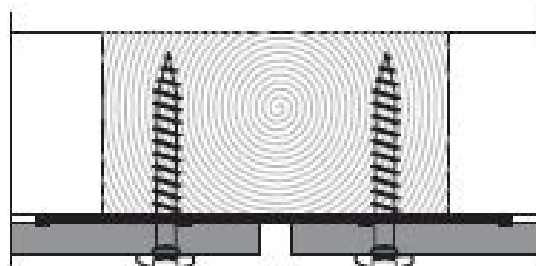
Coupe verticale sur joint horizontal (joint ouvert)
